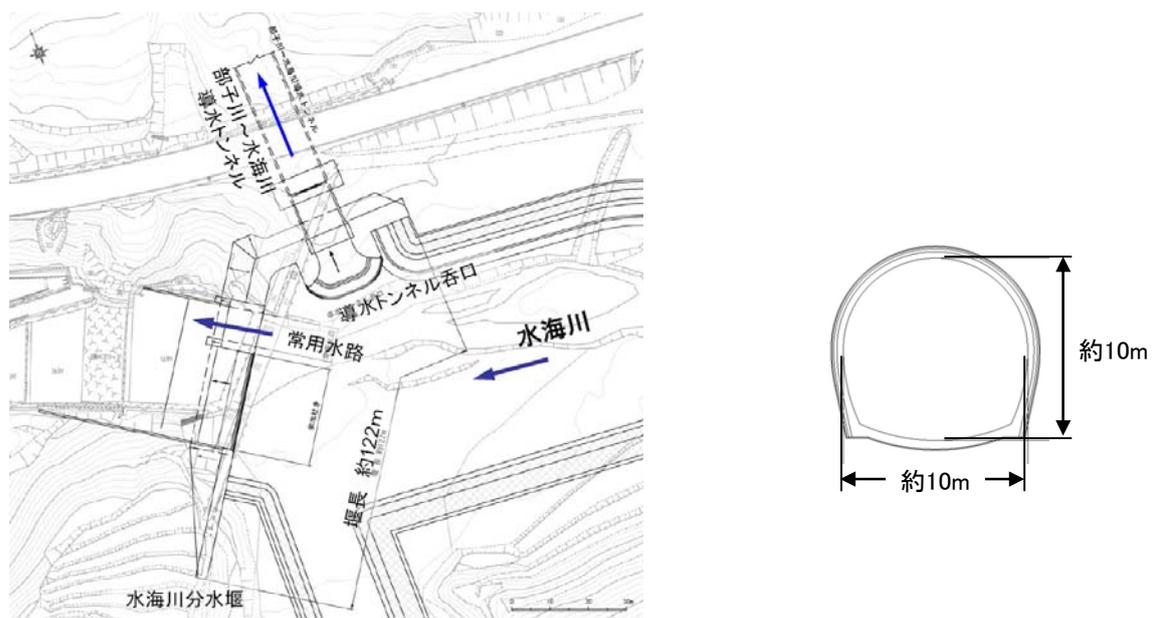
水海川分水堰平面図（左）と水海川導水トンネル断面図（右）
